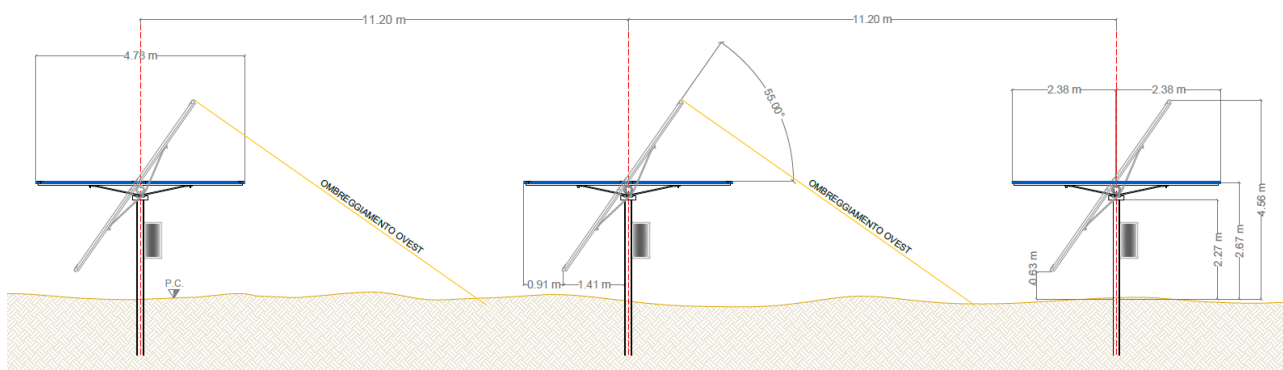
Vista frontale con rotazione di 55° ovest e distanza longitudinale tra le strutture
